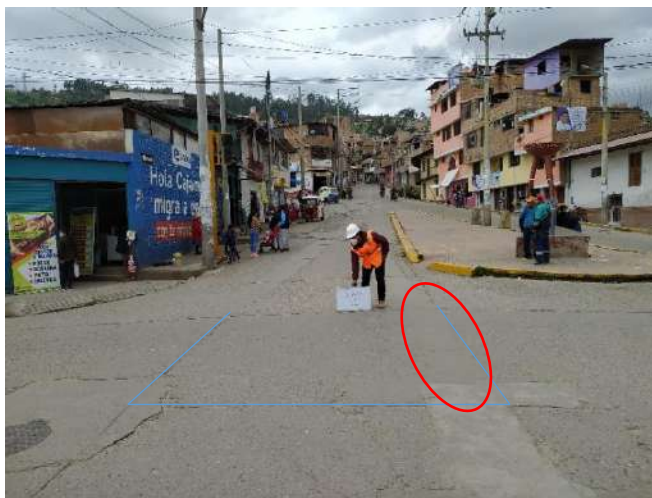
UM-25 Losa 435. Parcheo Grande - Grietas Lineales.
